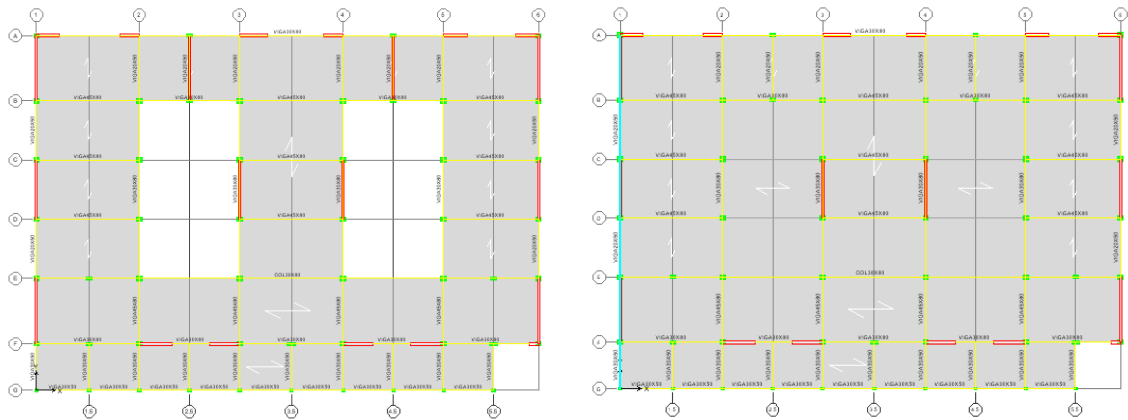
i. Distribución en planta de vigas, columnas, placas y losas utilizado en el análisis para un piso típico. Izquierda: del 1er y el 3er piso. Derecha: del 2do piso.
